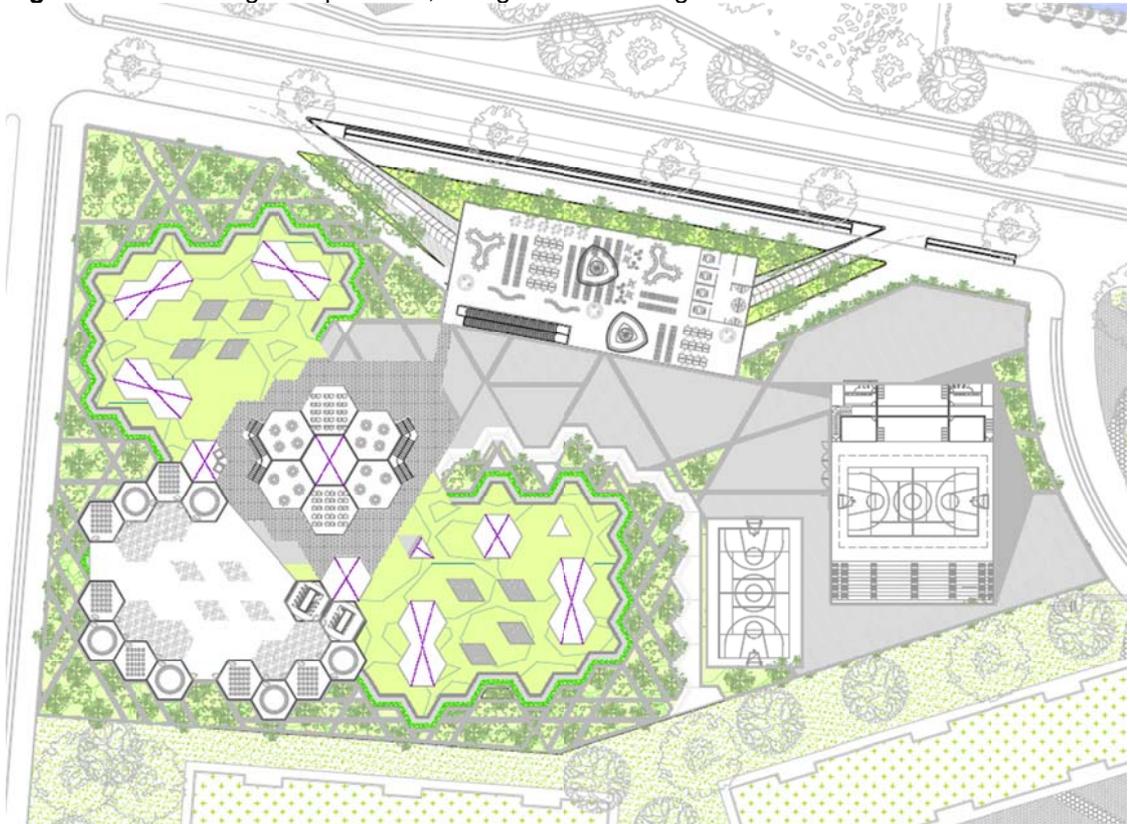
Planta primer piso Final, Colegio Daniel Arango
